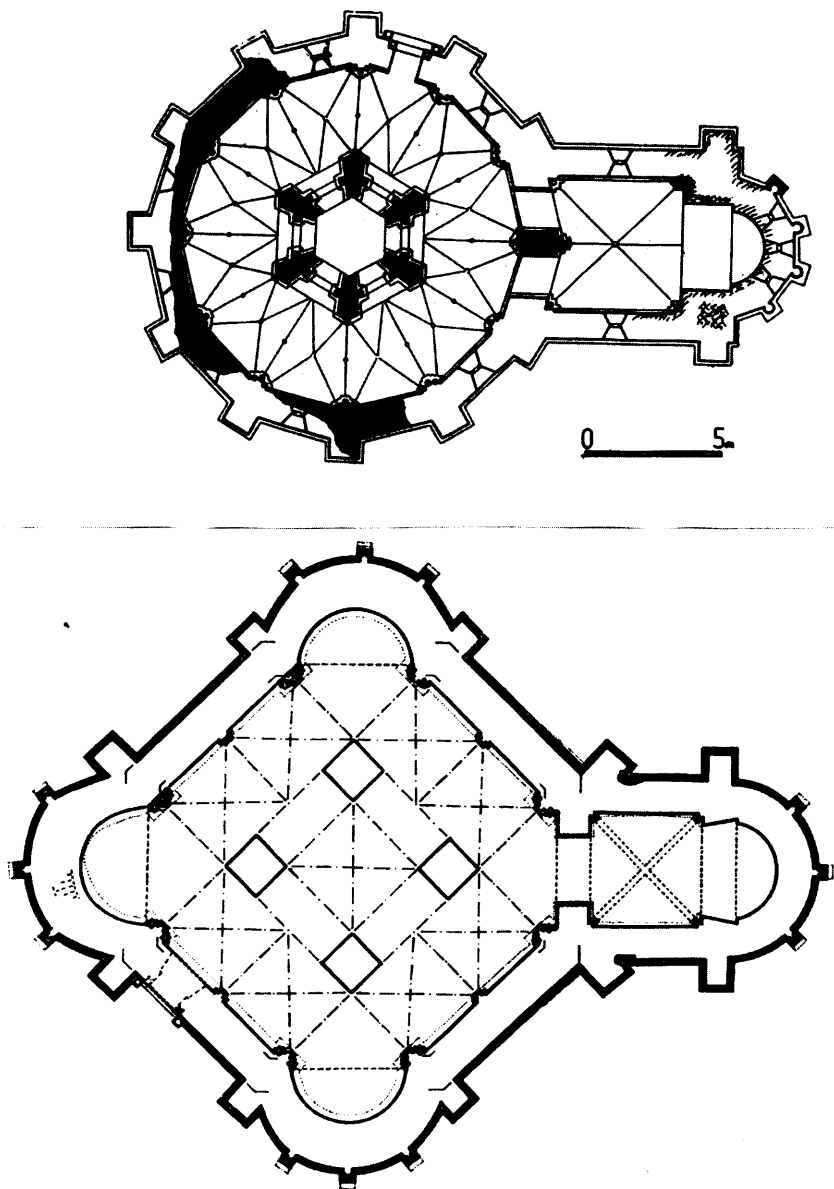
Liegnitz (oben) und Breslau, Grundrisse der ergrabenen Burgkapellen. In Breslau ist der nicht realisierte quadratische Einbau, der die Laterne hätte tragen sollen, rekonstruiert.
